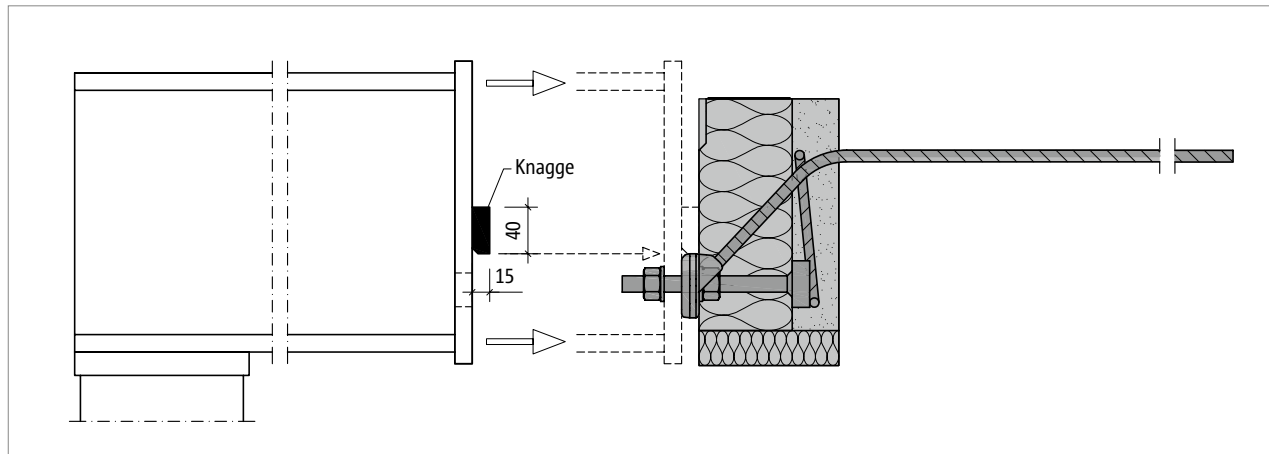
Schöck Isokorb® RT Typ SQ: Montage des Stahlträgers
